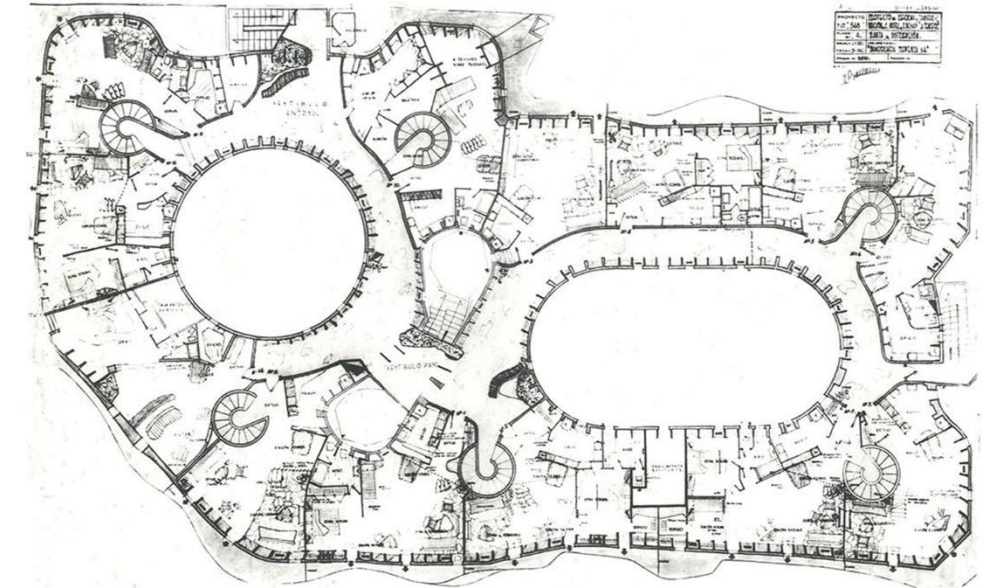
Antoni Gaudí. Plano de planta tipo. Casa Milà. Barcelona. 1906-12.
